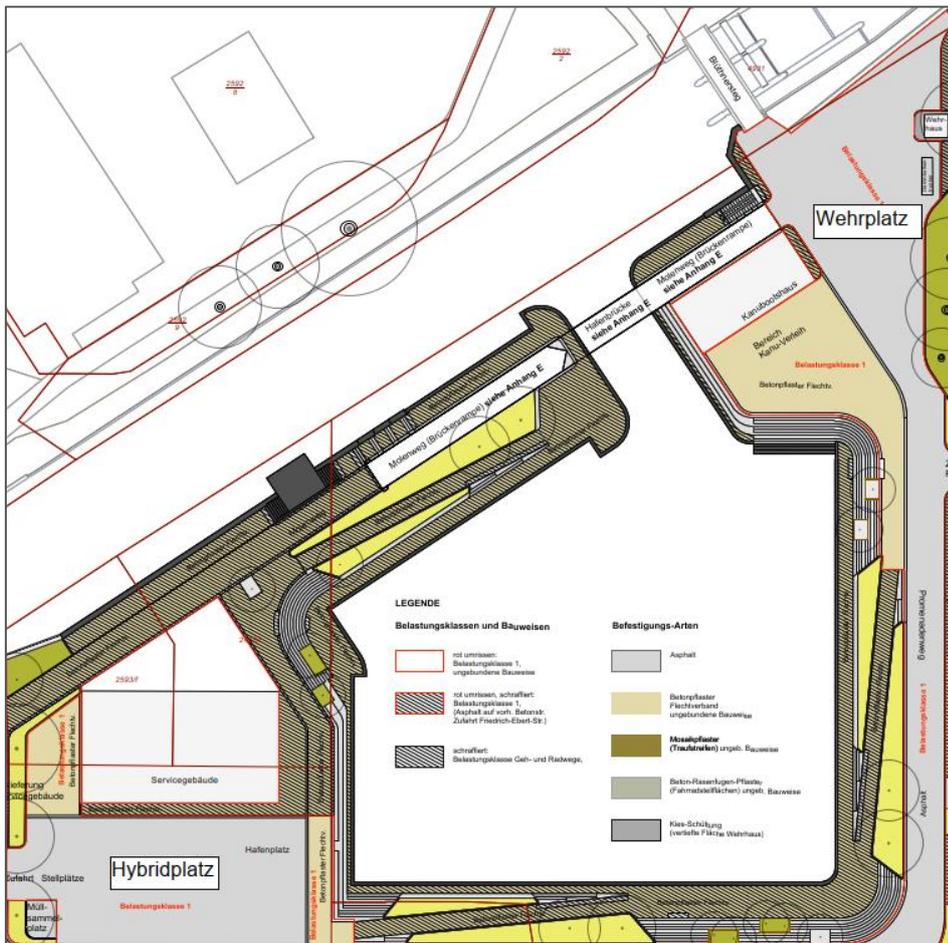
Lageplan Belastungsklasse (Quelle: Auszug Ausführungsplan Baulos 3 C1\_5-1-5\_LAGEPLAN\_Belastungskl\_M250\_221130)
